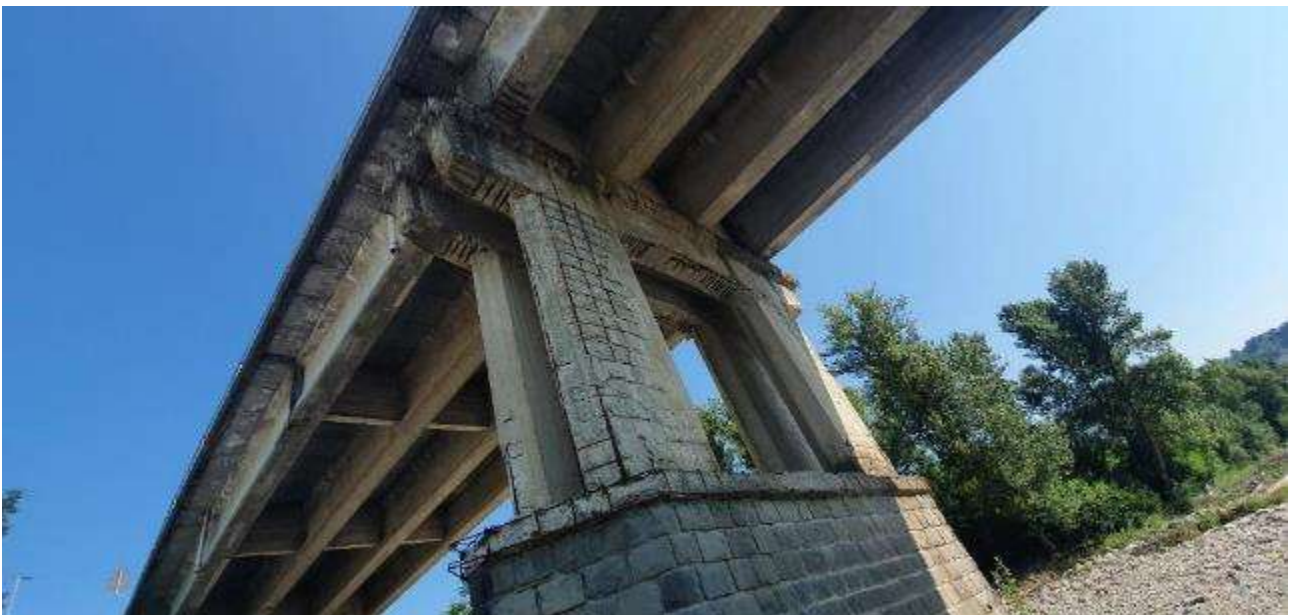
Vista del degrado di basamento-pila e trave pulvino
